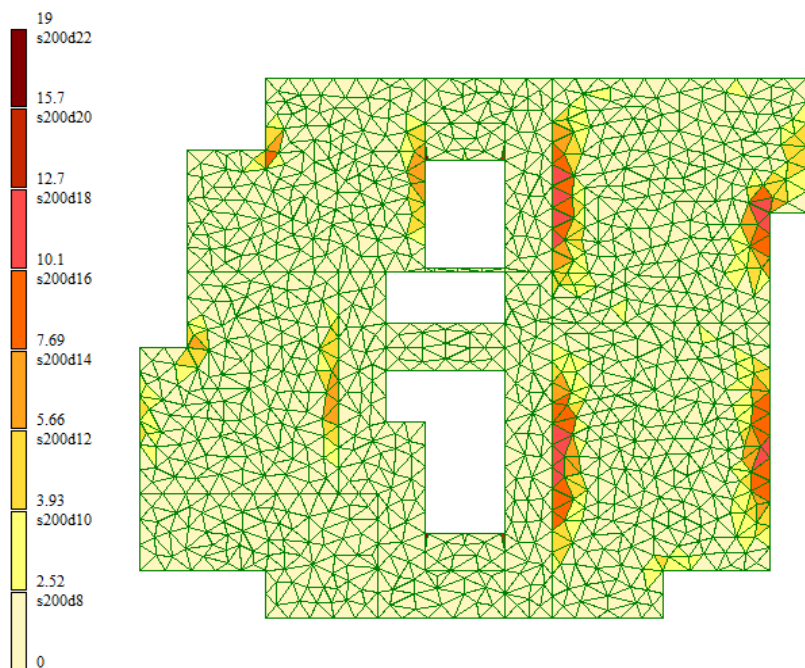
Схема армирования плит перекрытий по оси X (у верхней грани)
